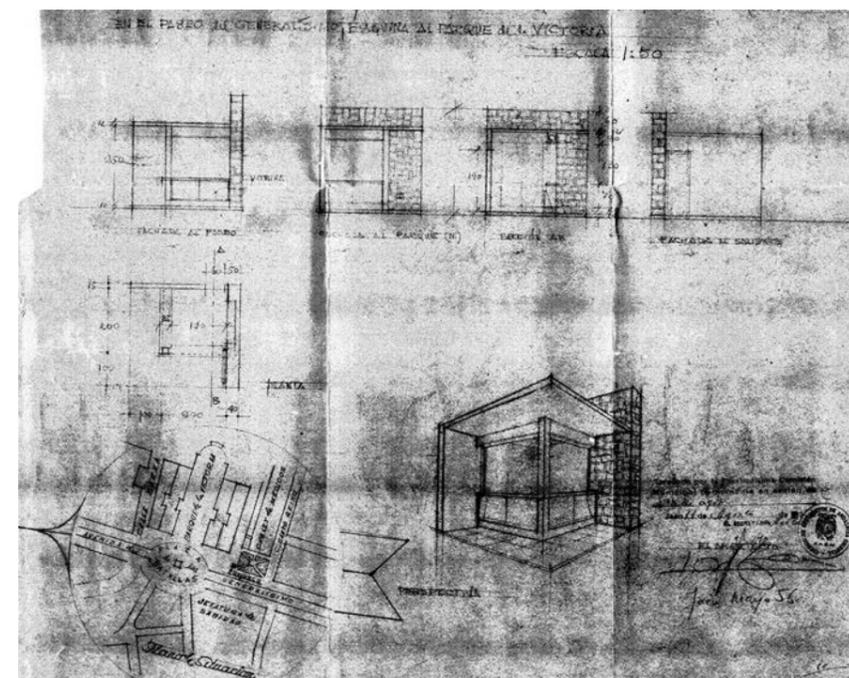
Plano del proyecto de Ramón Pajares. AMJ 1016018
